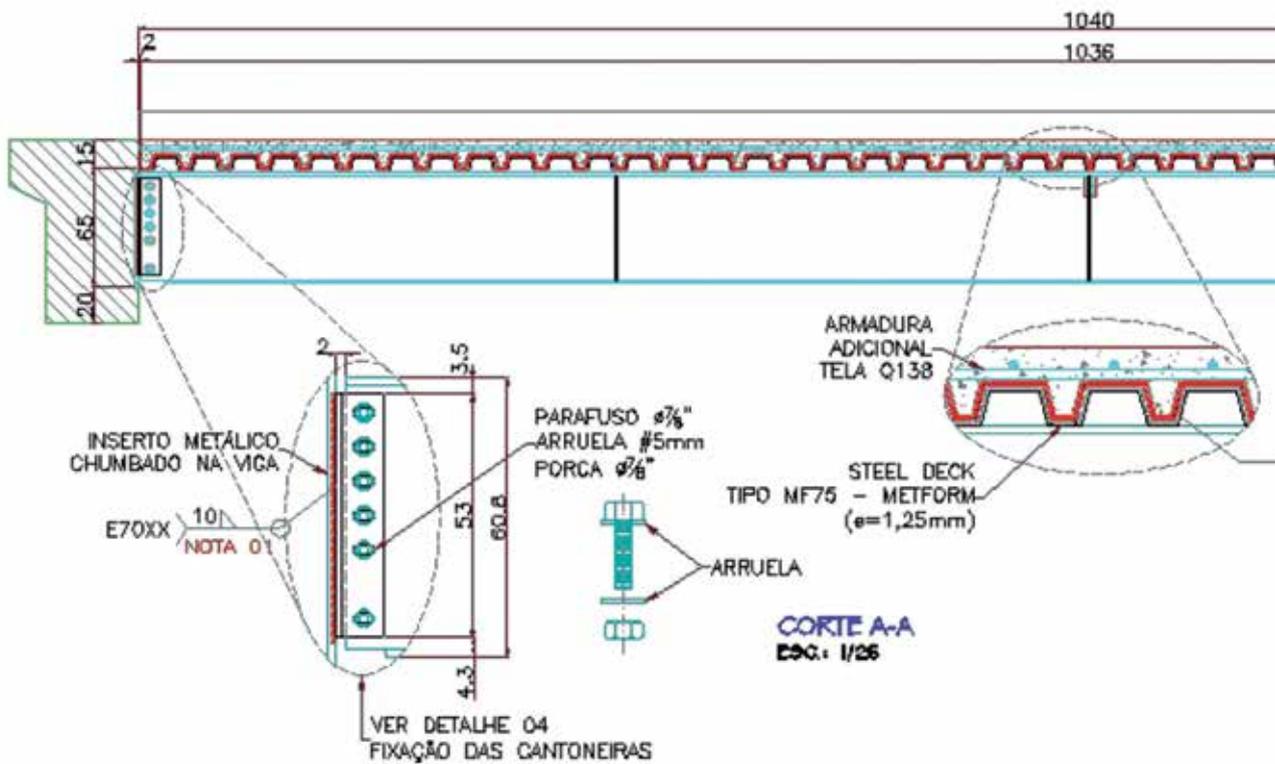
planta mostrando espaçamento entre estrutura de metal e concreto
